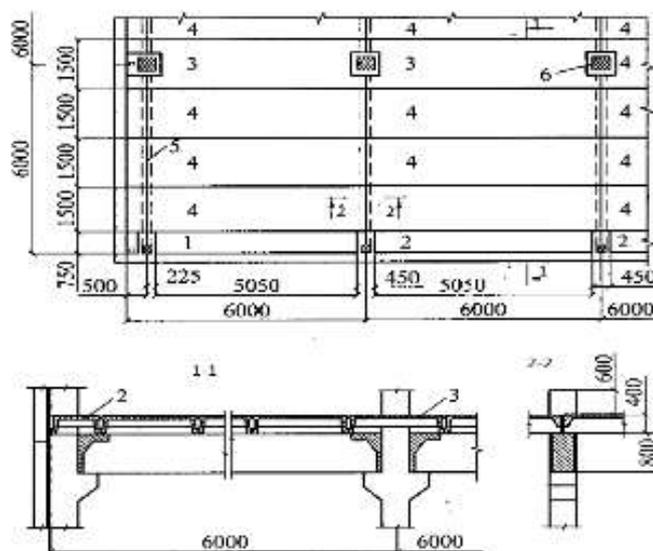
Перекриття з ригелями прямокутного перерізу:
